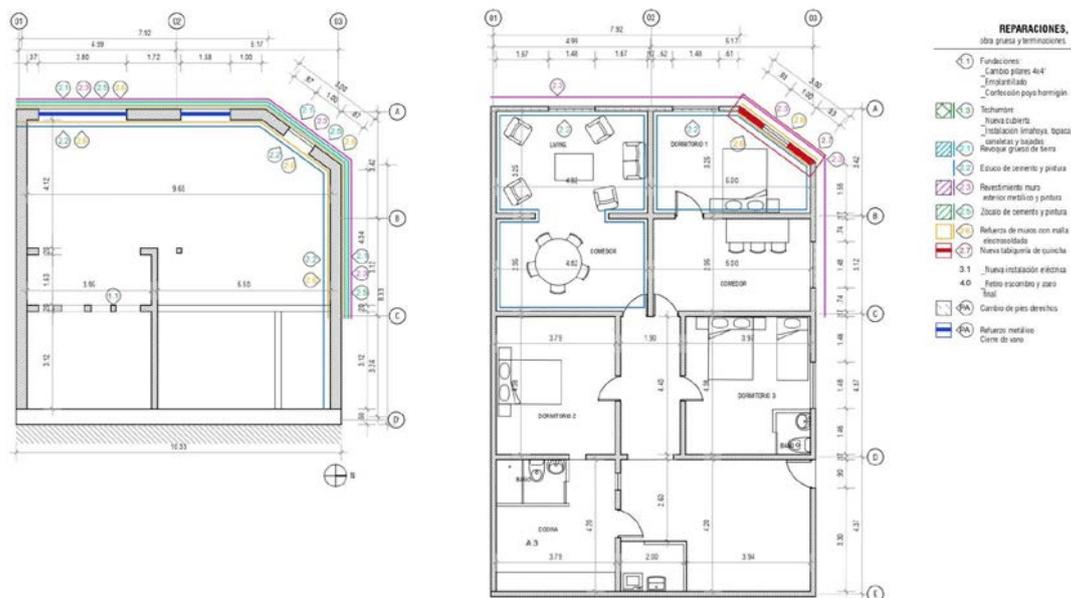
Planimetría de la vivienda y simbología de reparaciones.
